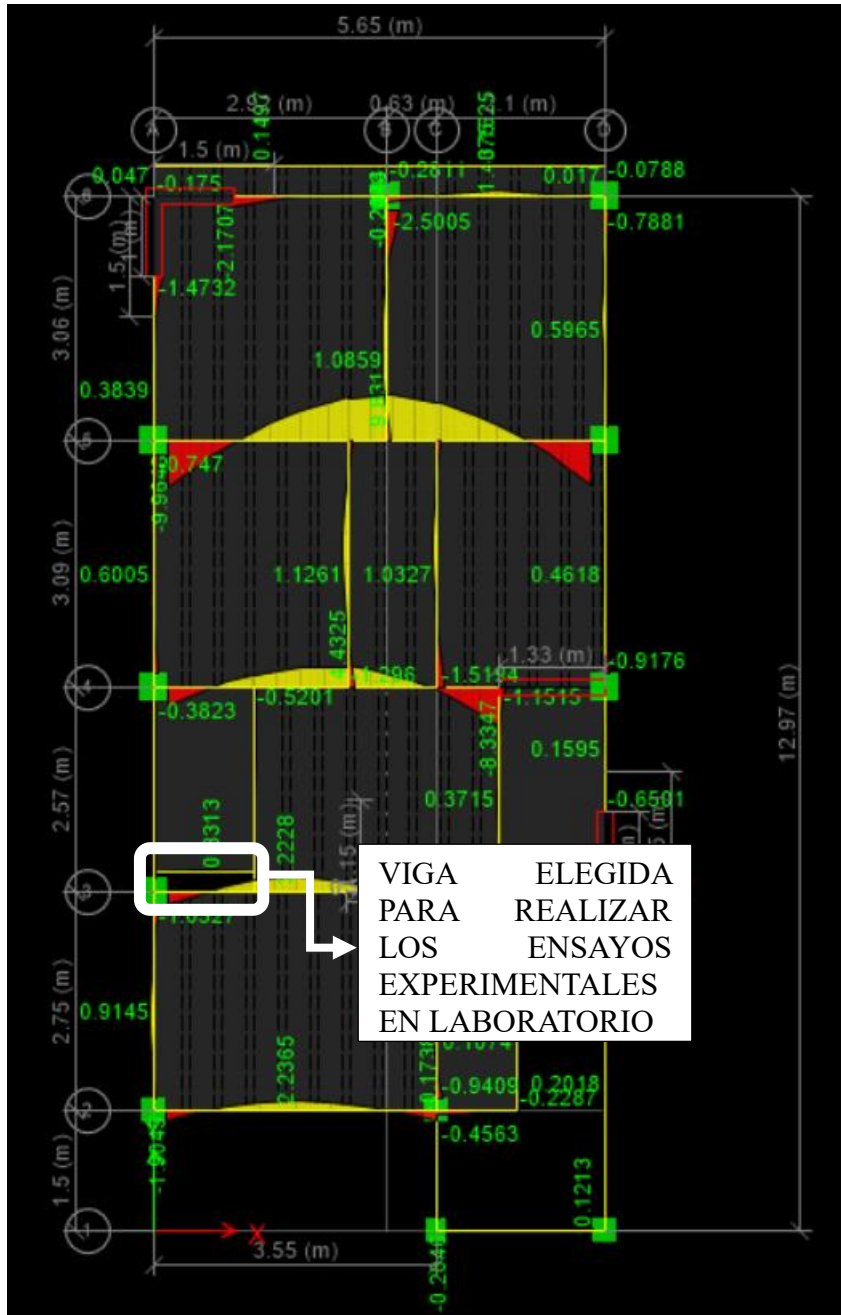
Viga de concreto armado, modelada matemáticamente, que se someterá a ensayos de flexión en laboratorio.
